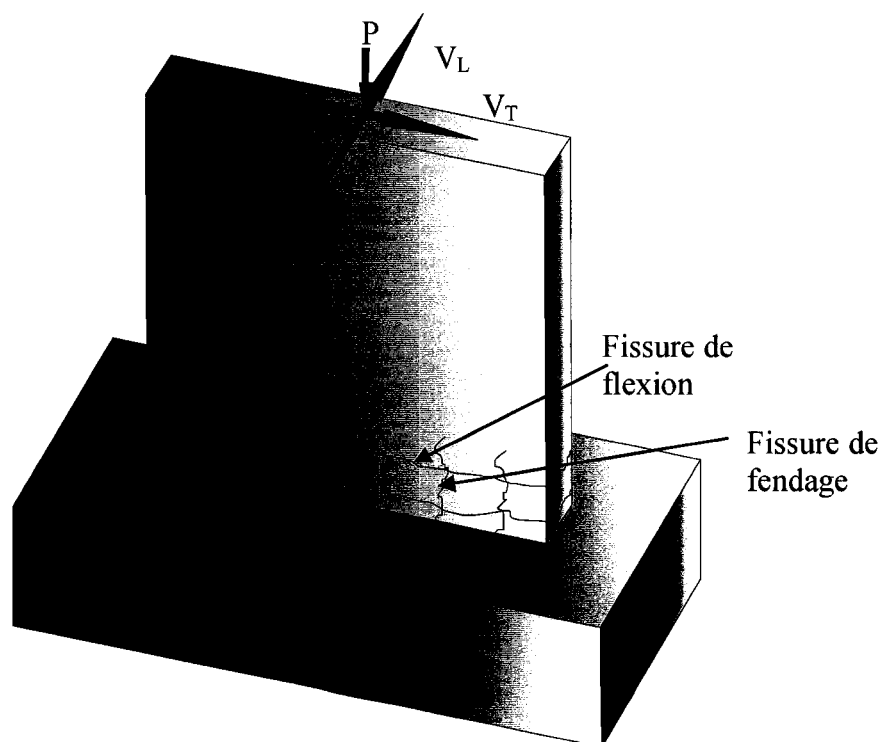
Patron de fissures typiques des chevauchements d'armature des piles rectangulaires
